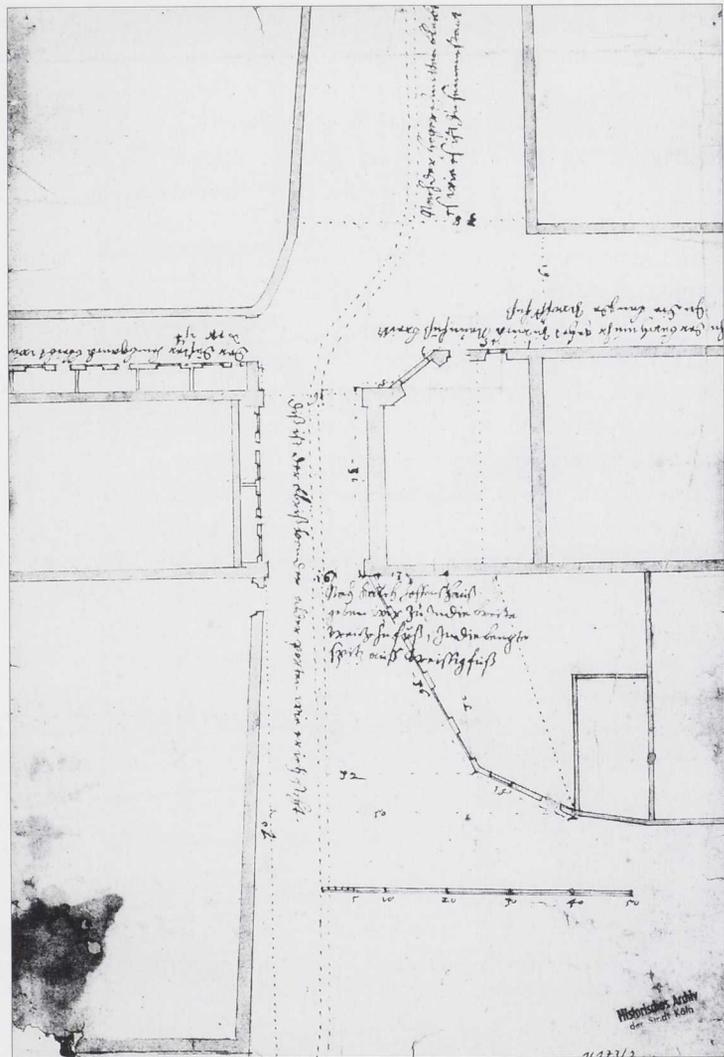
Plan der Straße »Unter Fettenhennen« (1823). Köln, Historisches Archiv.
